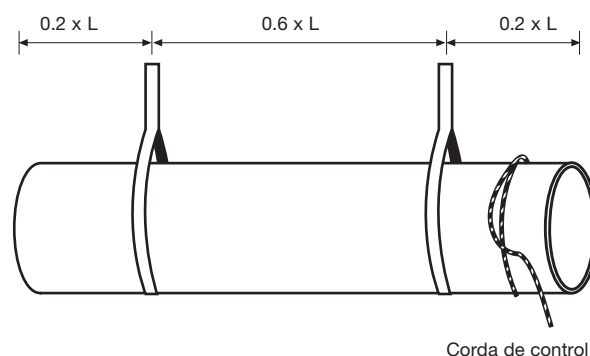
Levantamento de um tubo com dois pontos de fixação
